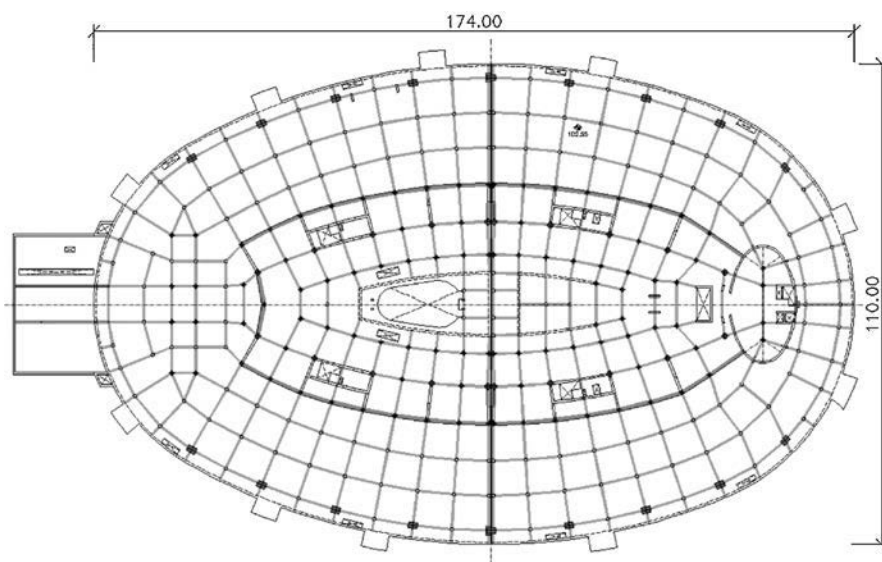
Estación Bir Mourad Raïs (Argel). Vigas y pilares plantas inferiores.
